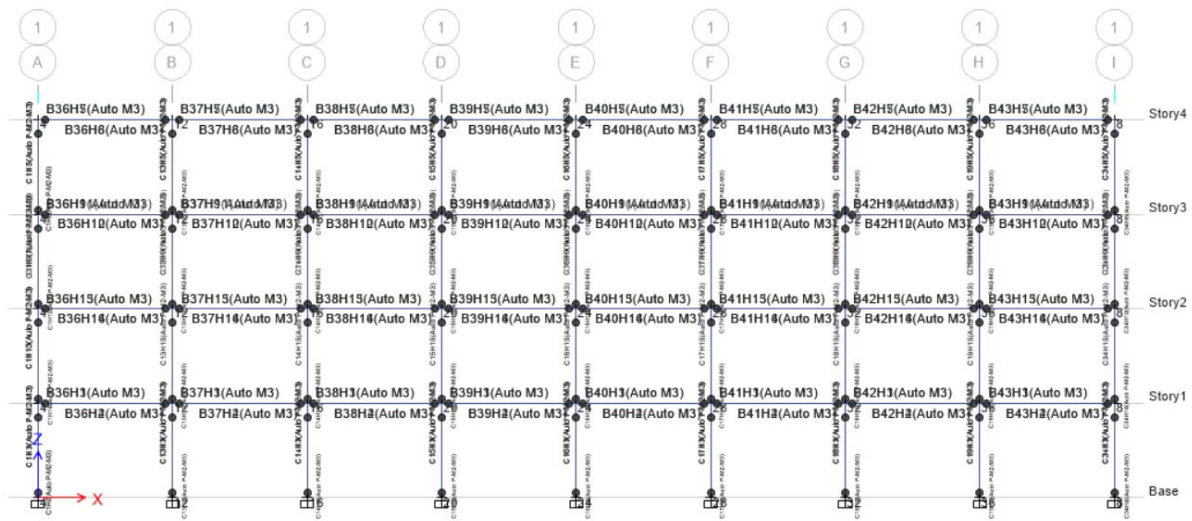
Definición de rótulas plásticas en columnas, elevación 1
